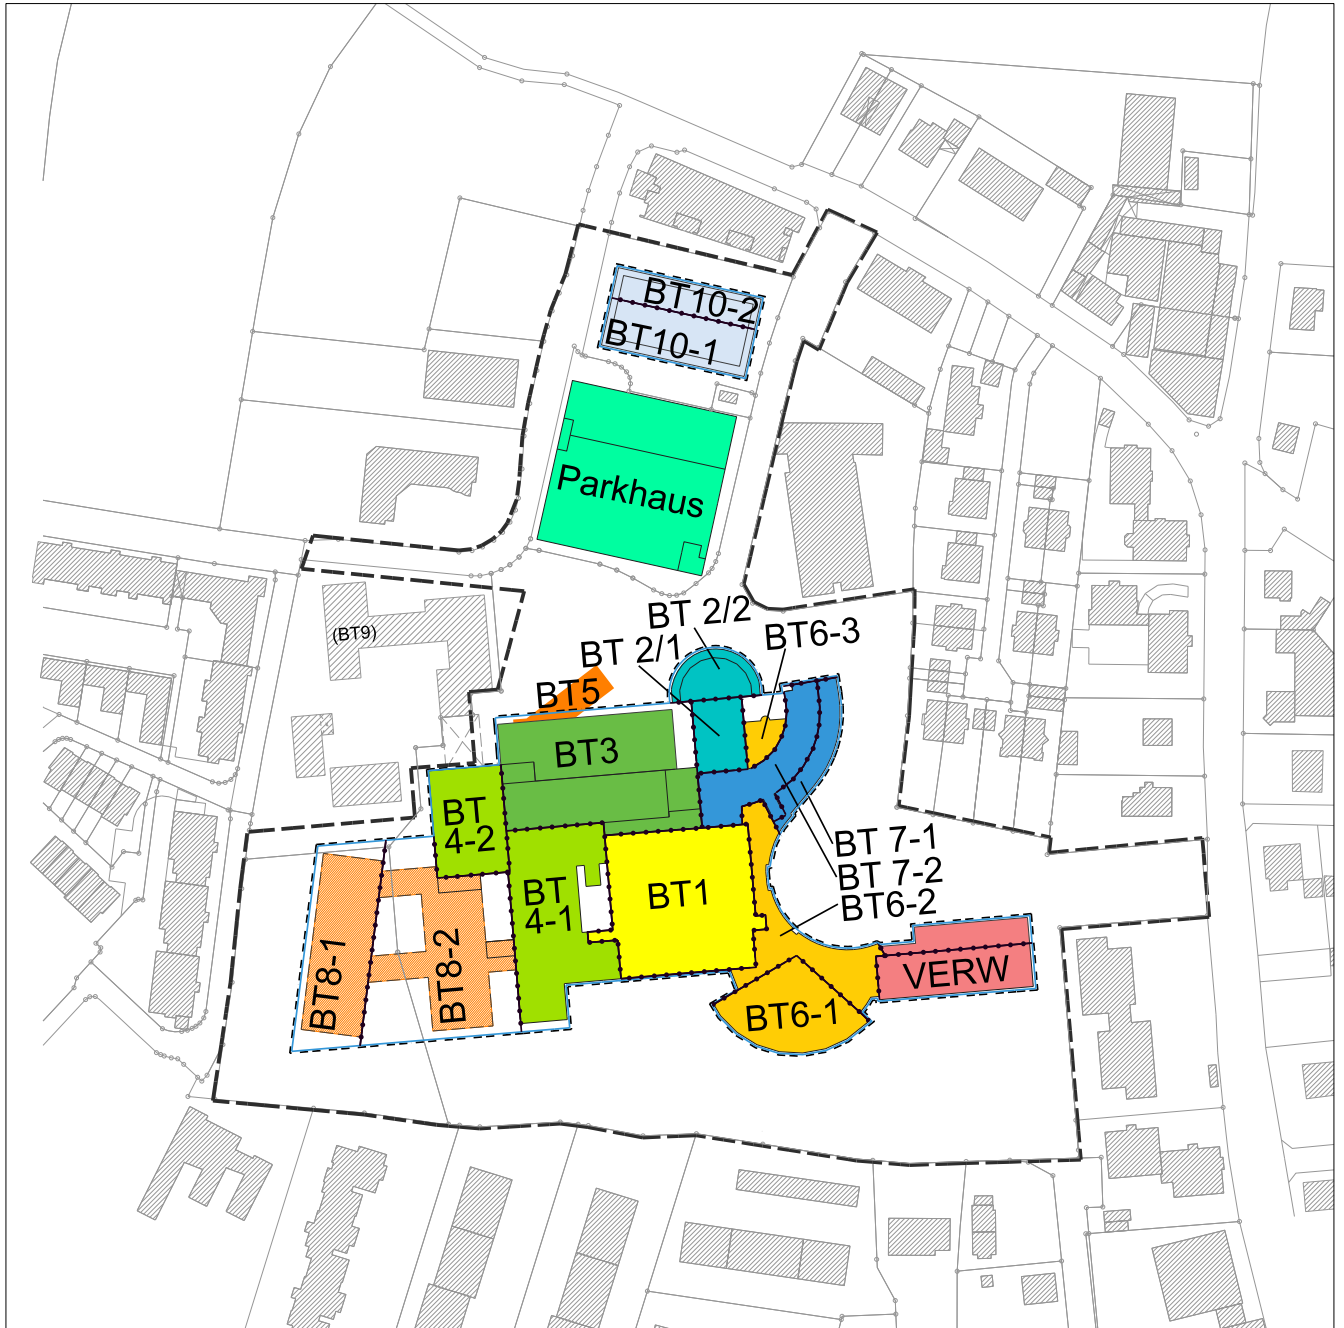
Lageplan Bauteilübersicht - Nachweis GRZ / GFZ nach § 19 und 20 BauNVO, ohne Maßstab
